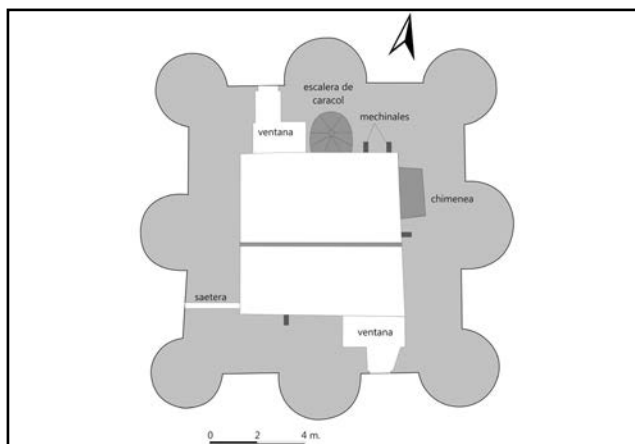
Hipótesis de reconstrucción de la planta segunda de la torre del homenaje.
